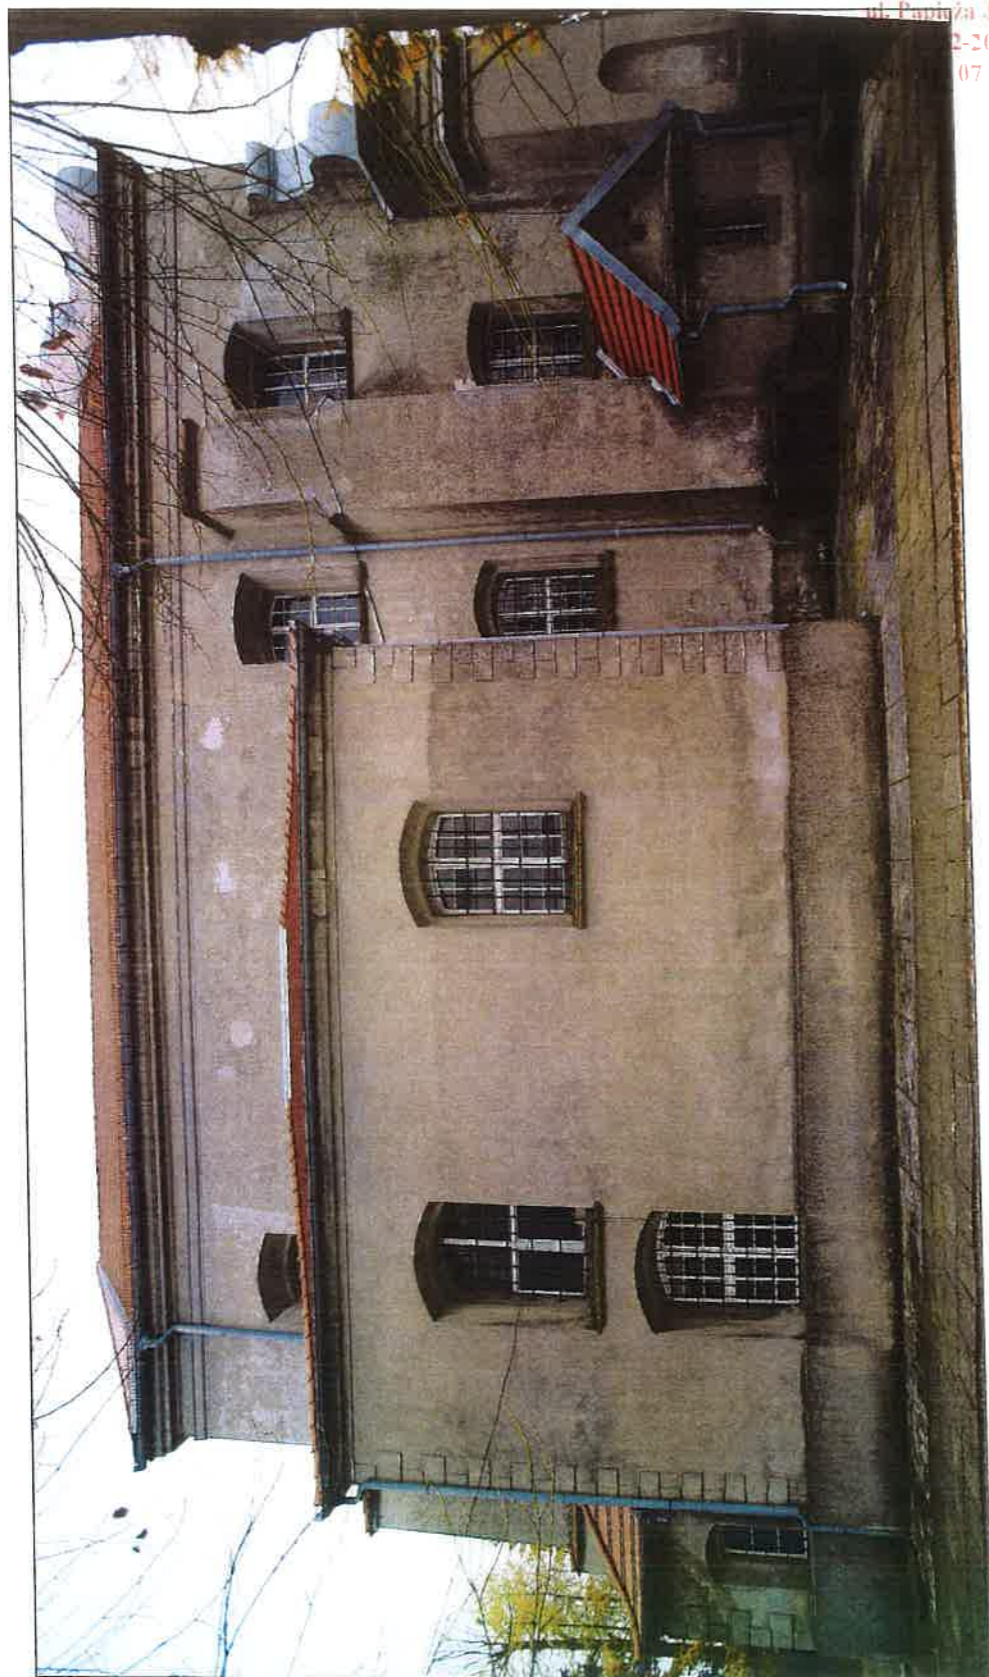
Widok ogólny elewacji zachodniej z poziomu placu przed kościołem.
